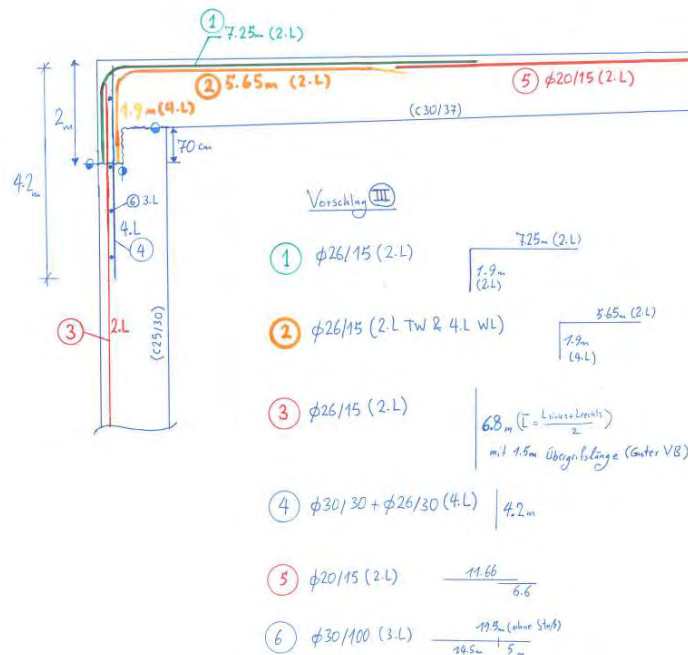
Bewehrungsskizze alternative Bewehrungsführung (z-Fuge).
